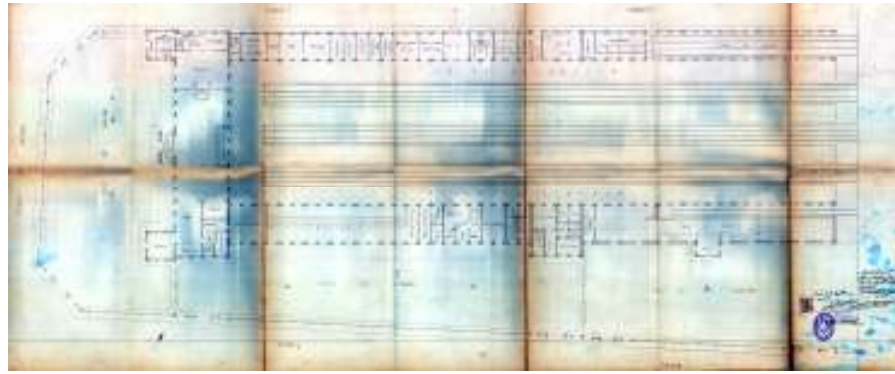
y 10.-Planta y vista interior del Länderbank (1882-1884).
